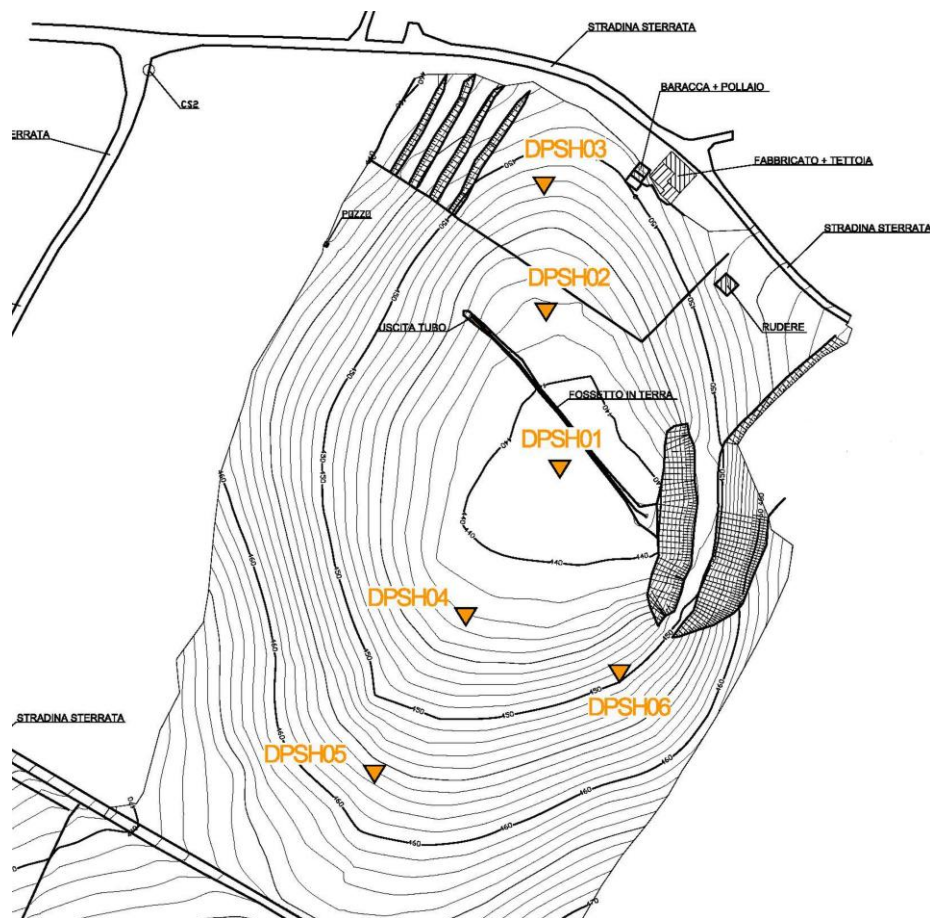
Planimetria prove penetrometriche dinamiche pesanti (DPSH).
